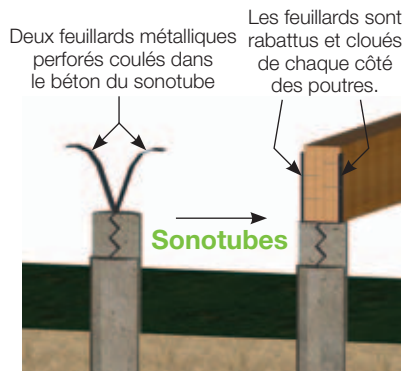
• Détail type d'un ancrage sur Sonotube
